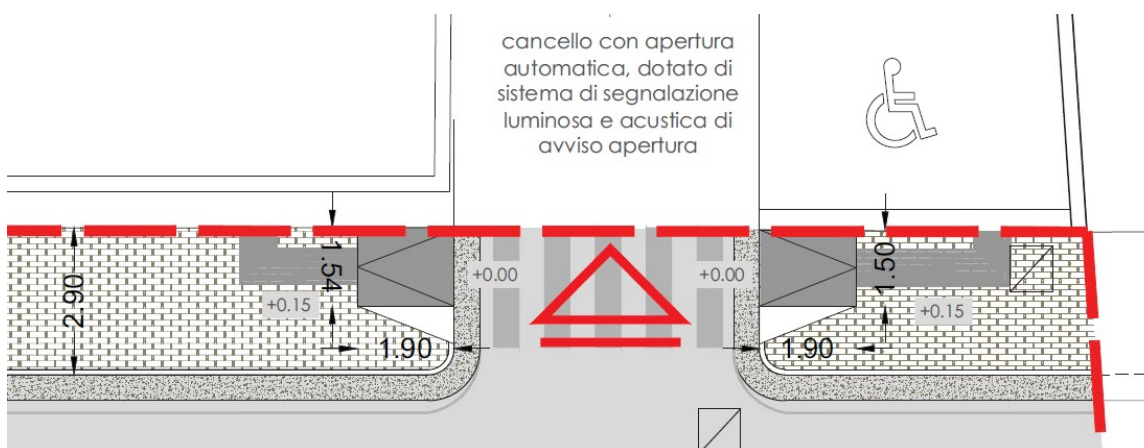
stralcio planimetria di progetto : marciapiede su via Attila Sallustro
